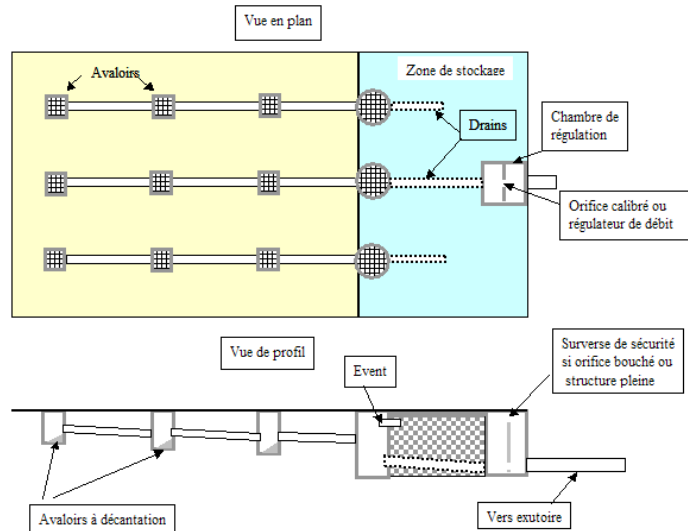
Schéma de principe d'une chaussée réservoir en béton
